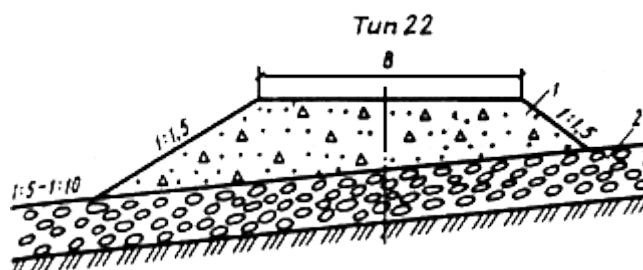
Поперечный профиль насыпи на курумах: 1 - грунт насыпи; 2 - курумы
